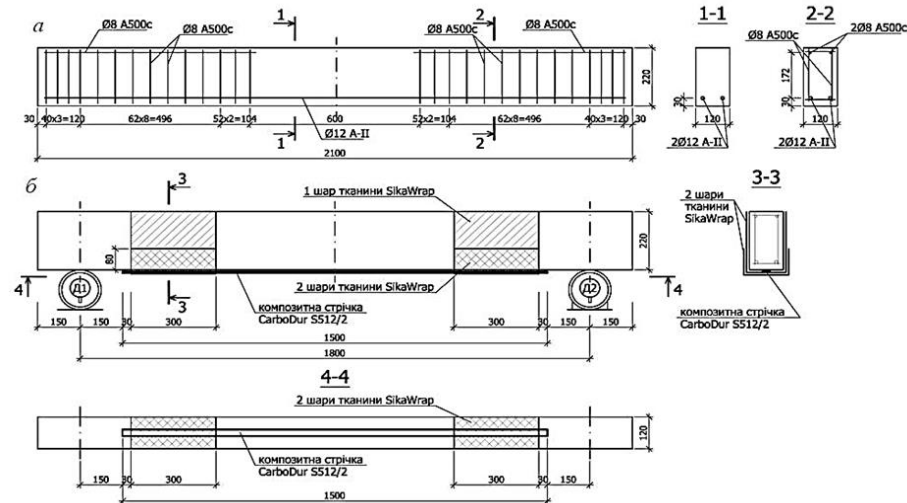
Конструкція дослідних балок: а – армування базової конструкції; б – конструкція підсилення балок
